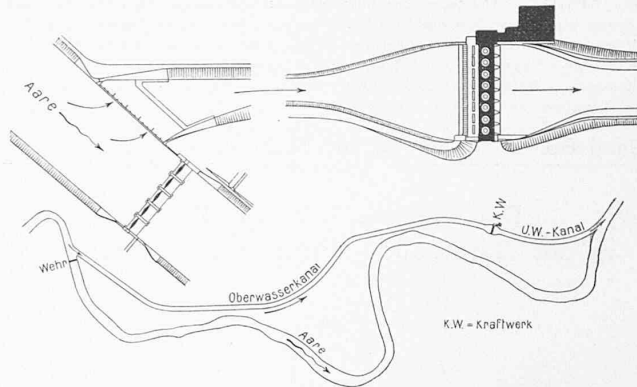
Reine Stauanlagen. — Lagepläne 1 : 7000.
